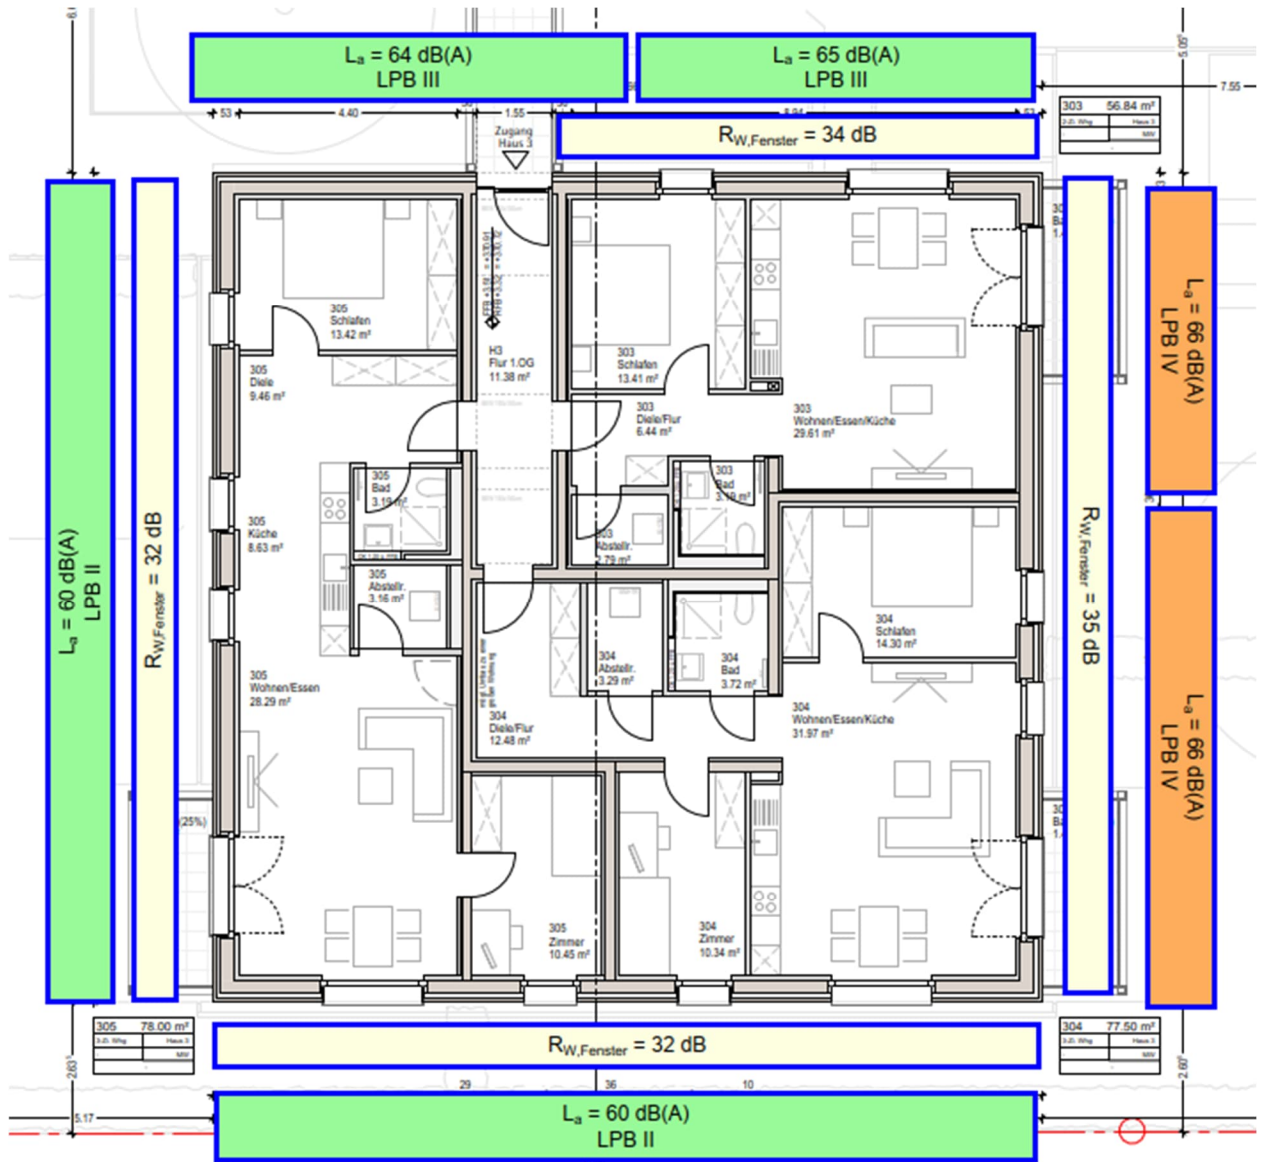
Außenlärm – Grundriss 1.OG – Haus 3
